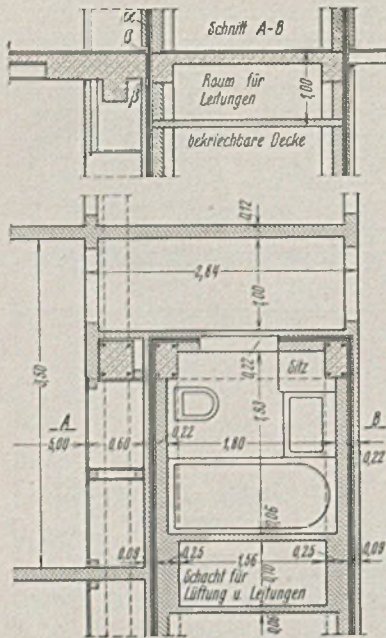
Ausschnitt aus einem Hotel-grundriß.
